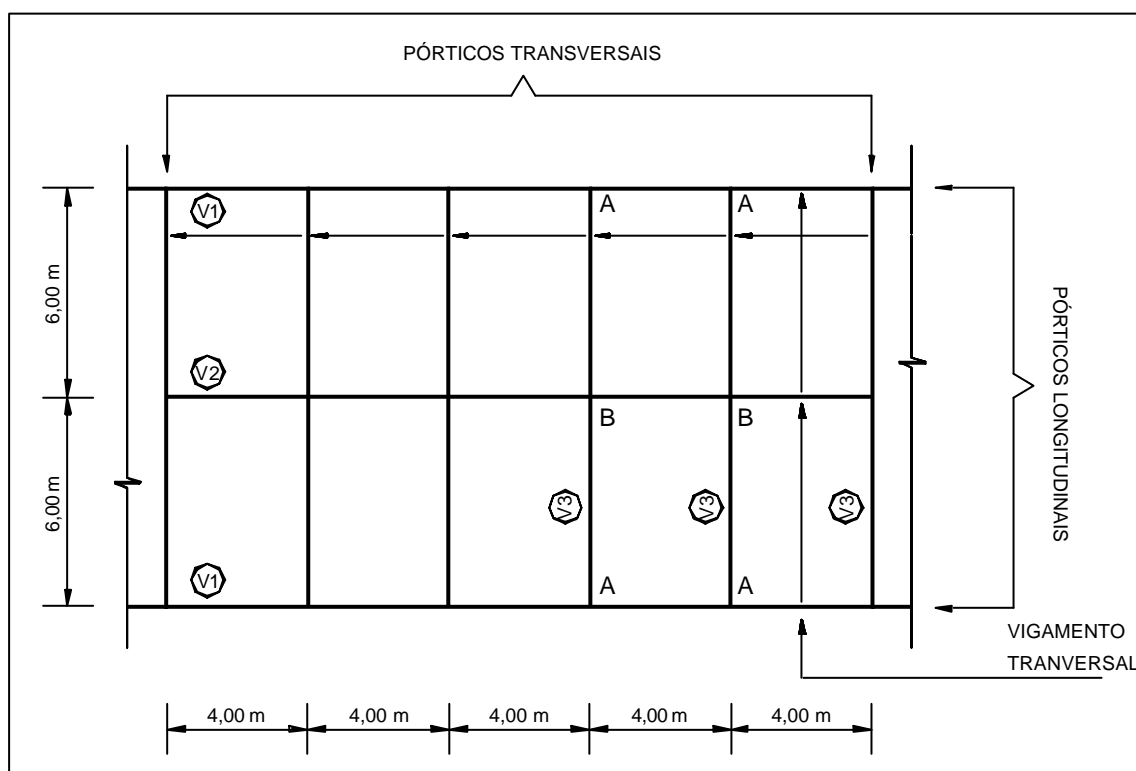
Croqui de parte da planta do pavimento tipo
